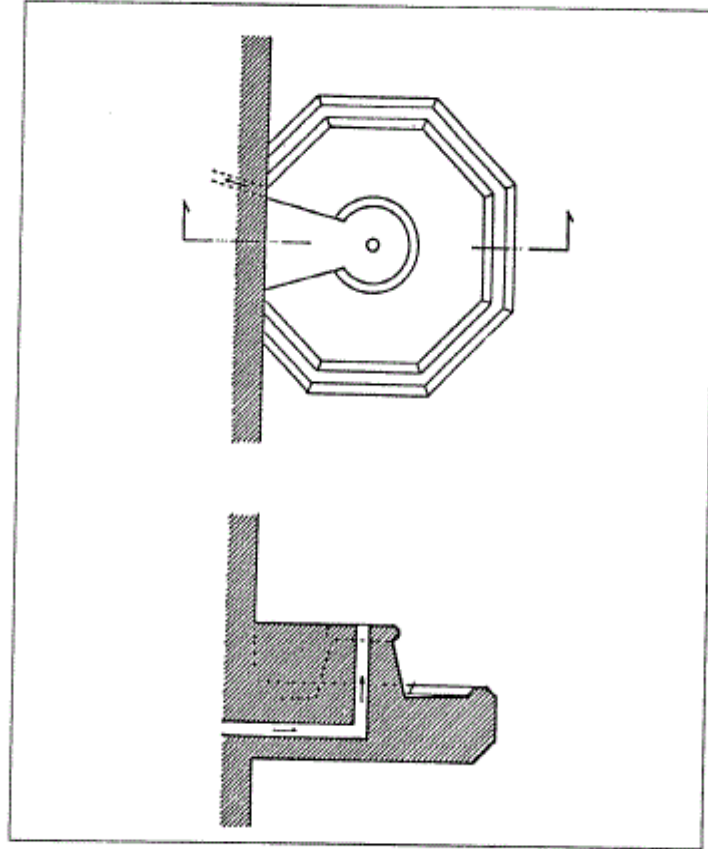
مسقط أفقي لجشمة قره مصطفى باشا في أدرنة (عن: ÖNGE).
